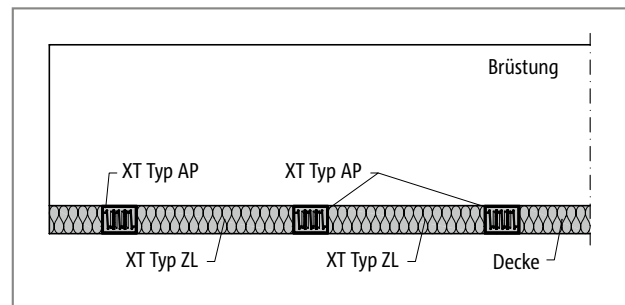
Schöck Isokorb® XT Typ AP horizontale Anordnung: Ansicht Brüstung vorgesetzt
